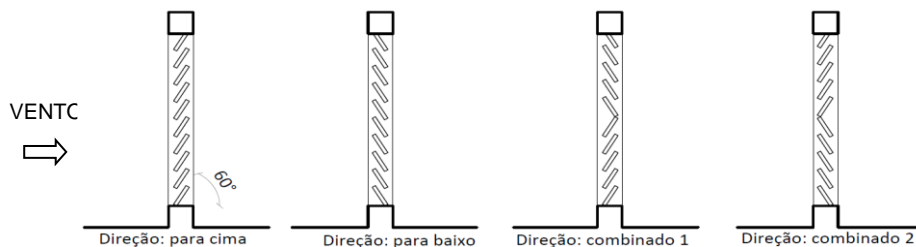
Cortes demonstrando as configurações do muro vazado com lâminas horizontais com inclinação de 60°.
